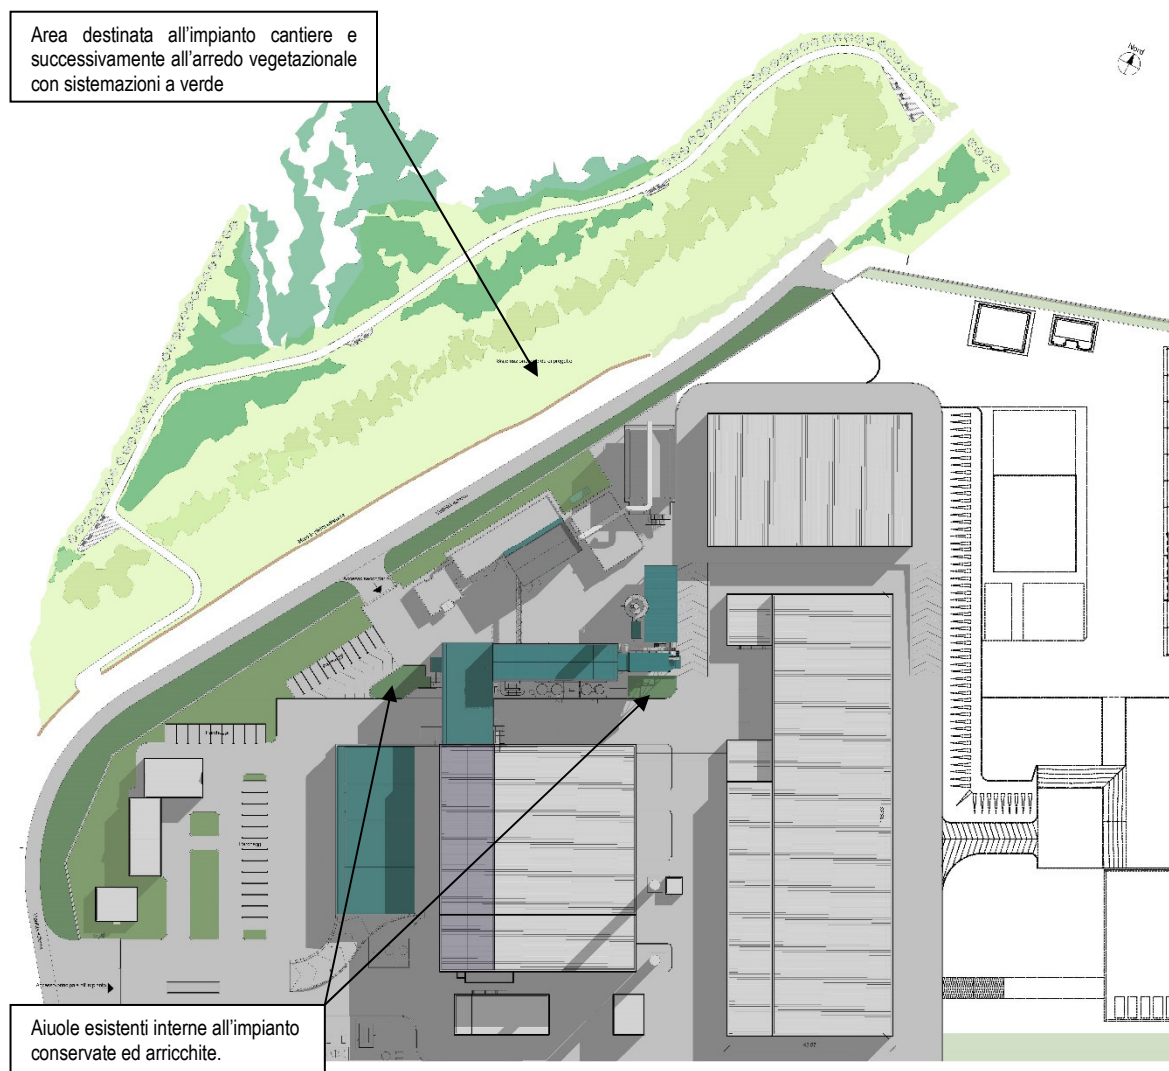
Planimetria generale dell'Impianto di progetto completa delle aree di pertinenza a verde
